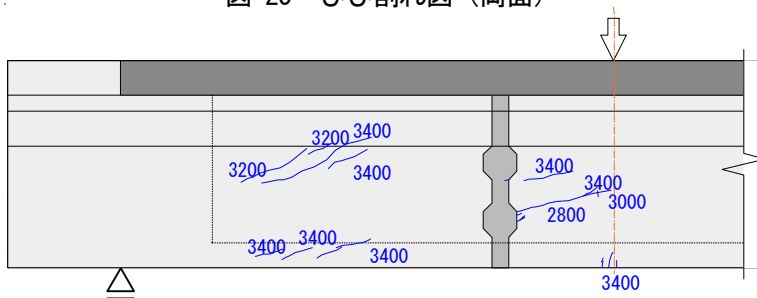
ひび割れ図：拡大 (Aライン側)
